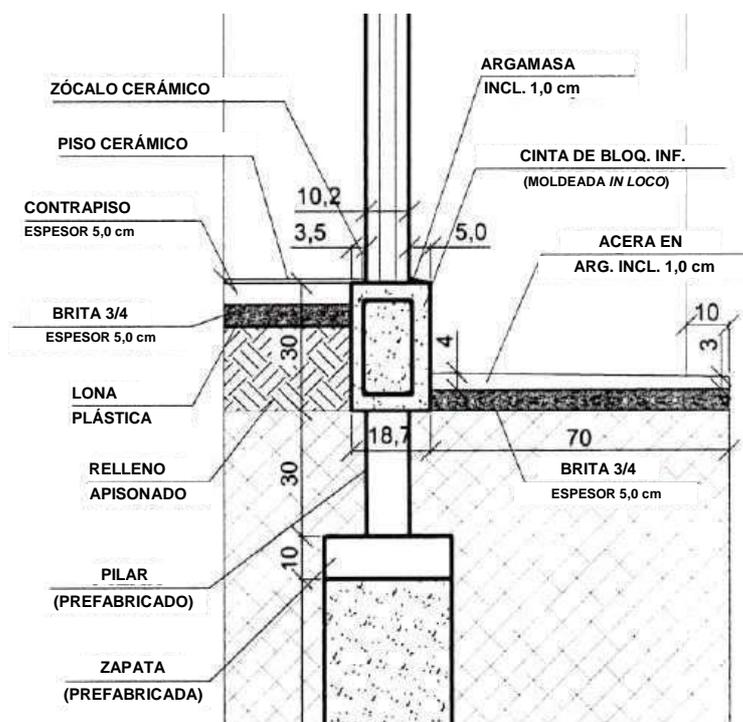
Detalle – junta de viga de cimentación y de placas de hormigón premoldeadas.
